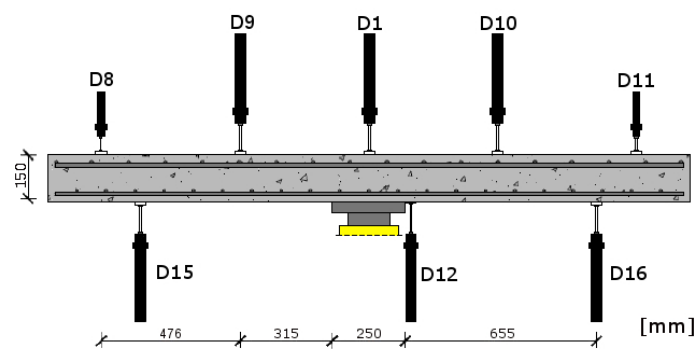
Distribuição de defletómetros em planta (superior e inferior (adaptado de [8]))
